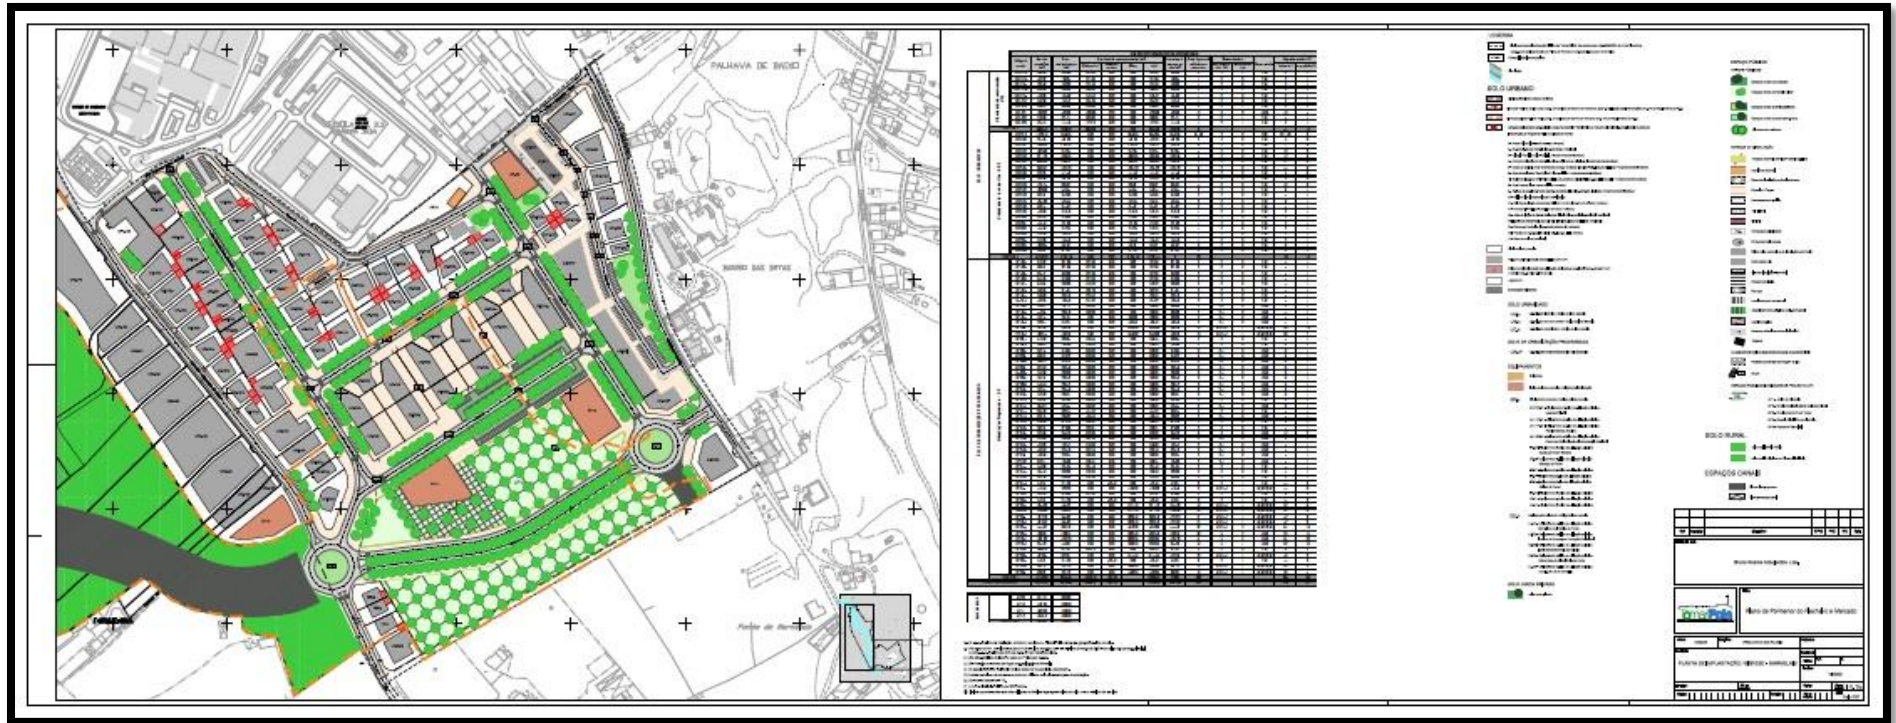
Planta de Ordenamento do Plano de Pormenor do Flecheiro e Mercado.
